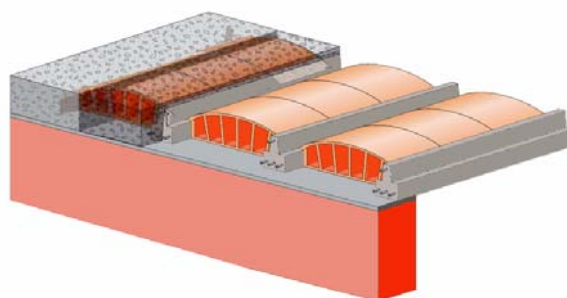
Pavimento de vigotas pré-fabricadas.
